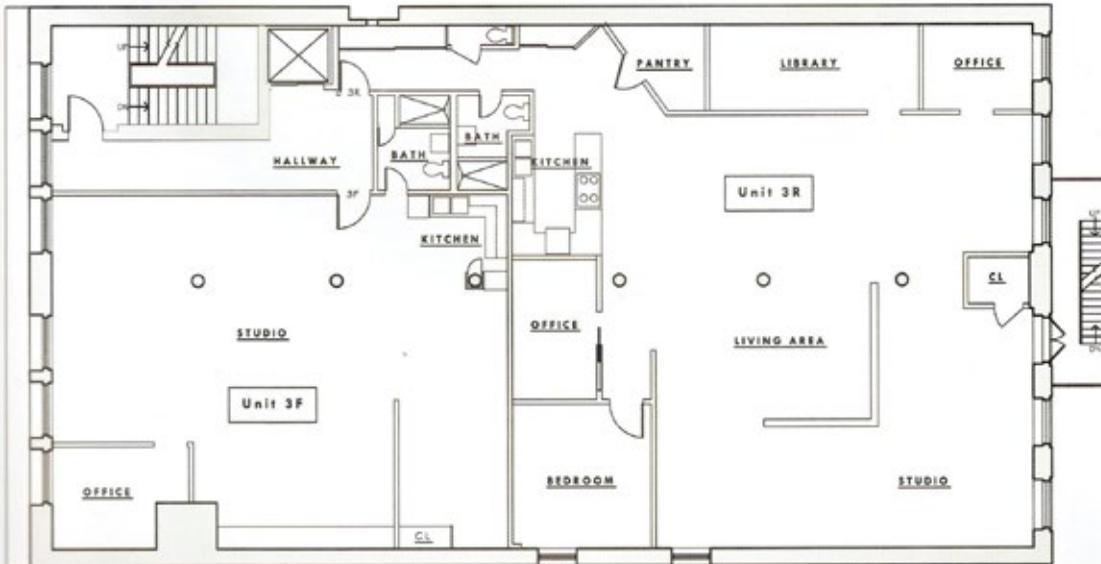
Cozinha no terceiro pavimento. Fonte: SHAPIRO (2010).
